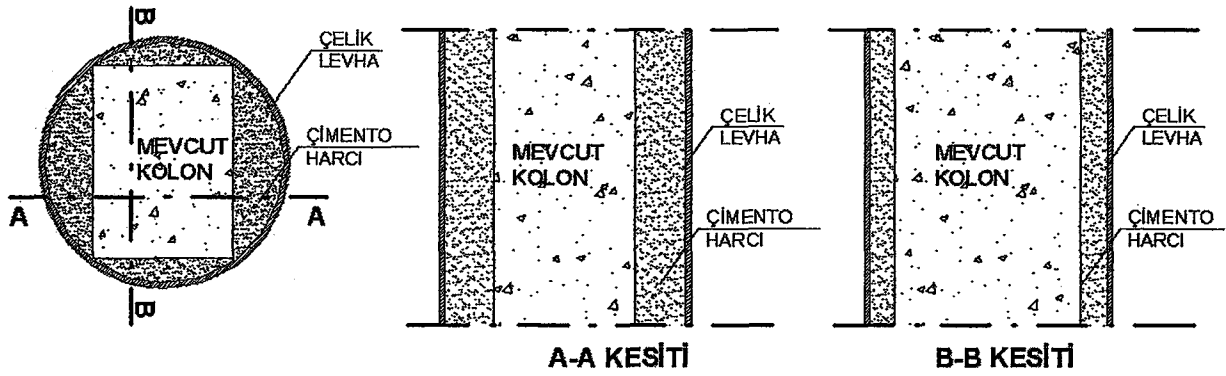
Betonarme kolonun çelik lamalar kullanılarak güçlendirilmesi detayı
